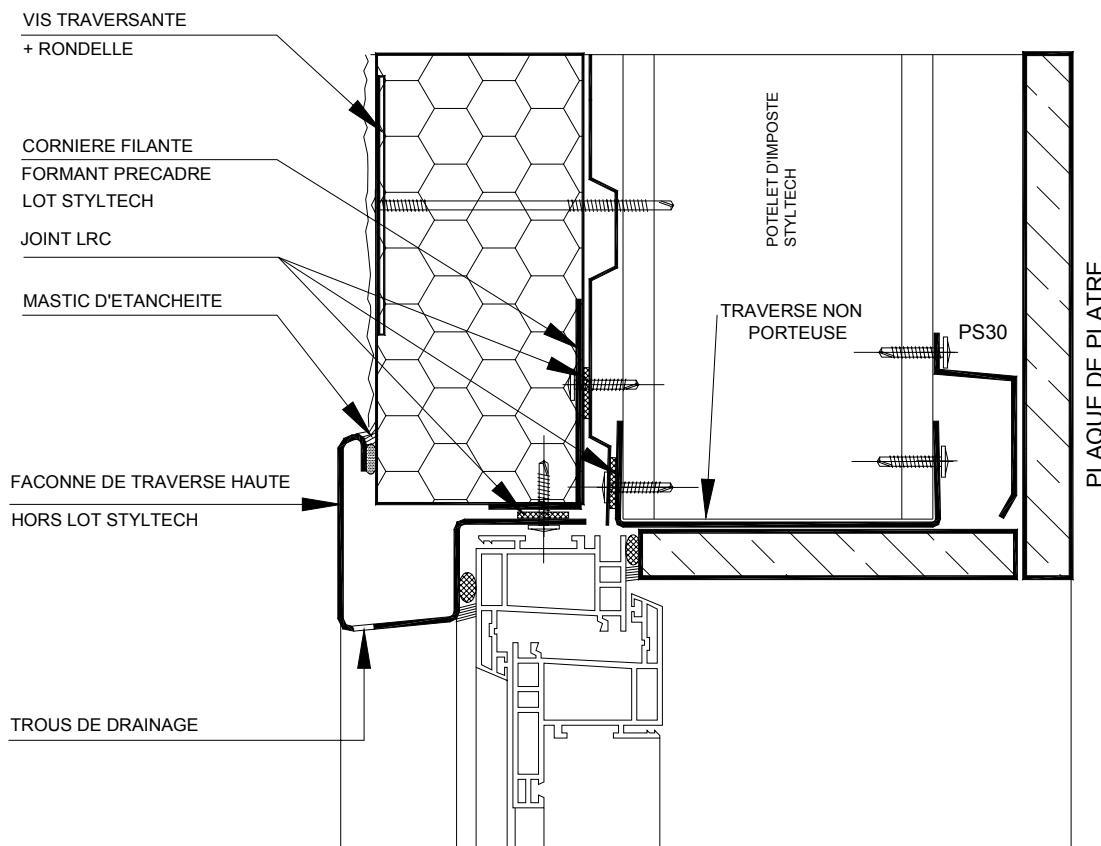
Coupe verticale sur fenêtre – Traverse haute – Menuiserie au nu extérieur
